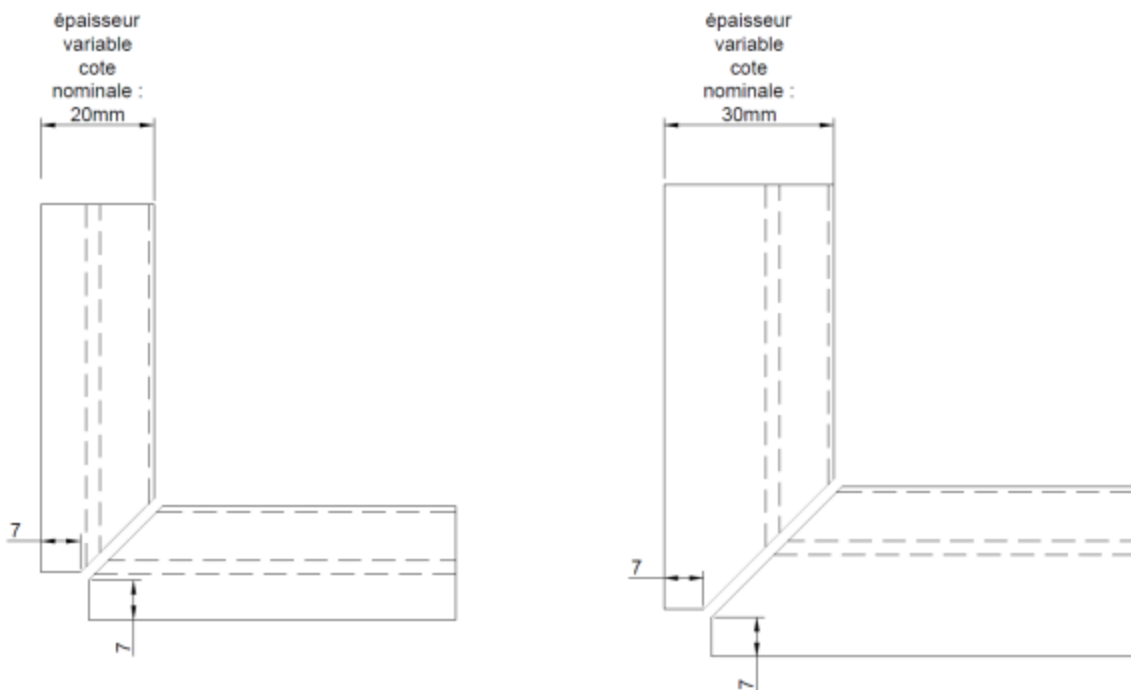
Exemple d'usinage Bec d'oiseau pour angle sortant pierre 2 et 3 cm
